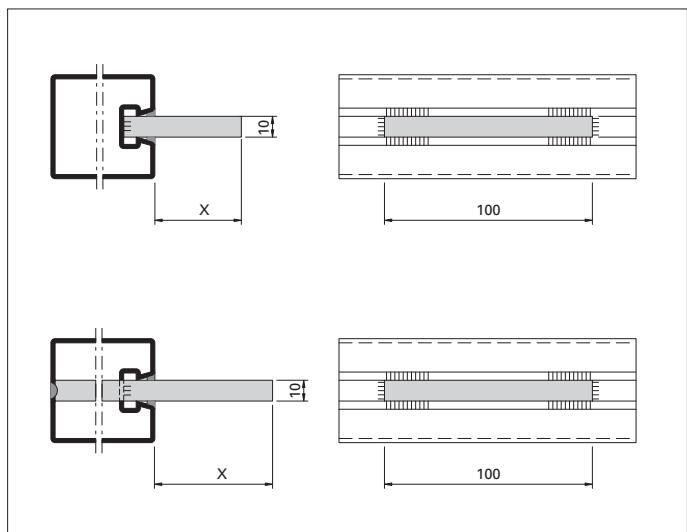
Spezial-Glasauflagen eingeschweißt (durch Metallbauer herzustellen)
